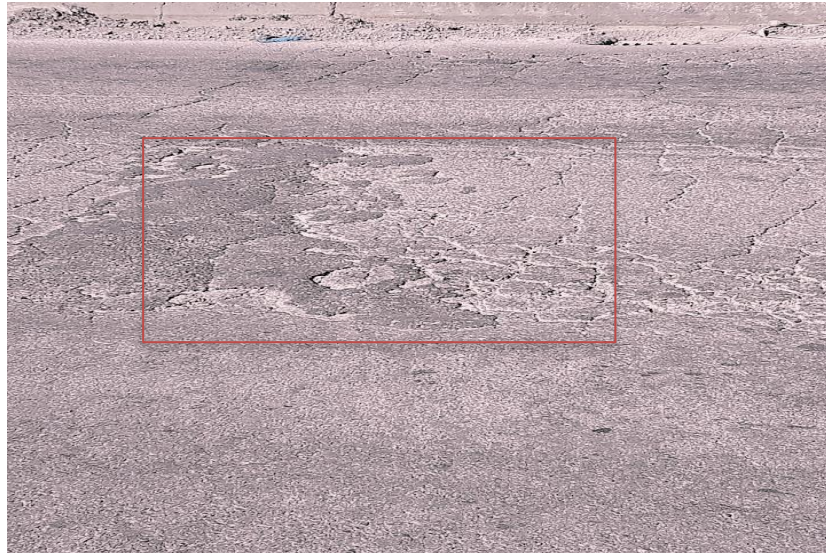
Fisuras en bloque de nivel de severidad media
